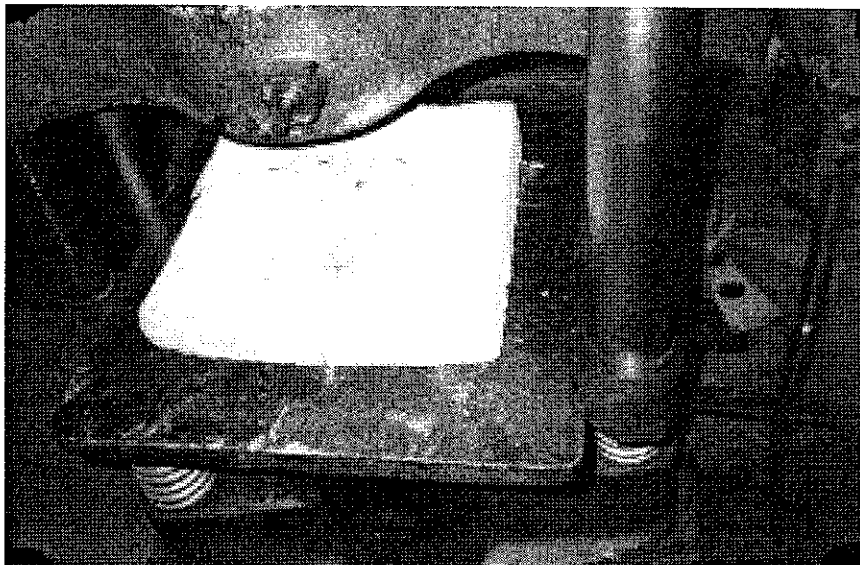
Al retirar la sección metálica se aprecia que las fallas por flexión a la orilla de la tapadera se unieron a las fallas por corte punzonante producidas al centro de la misma.
